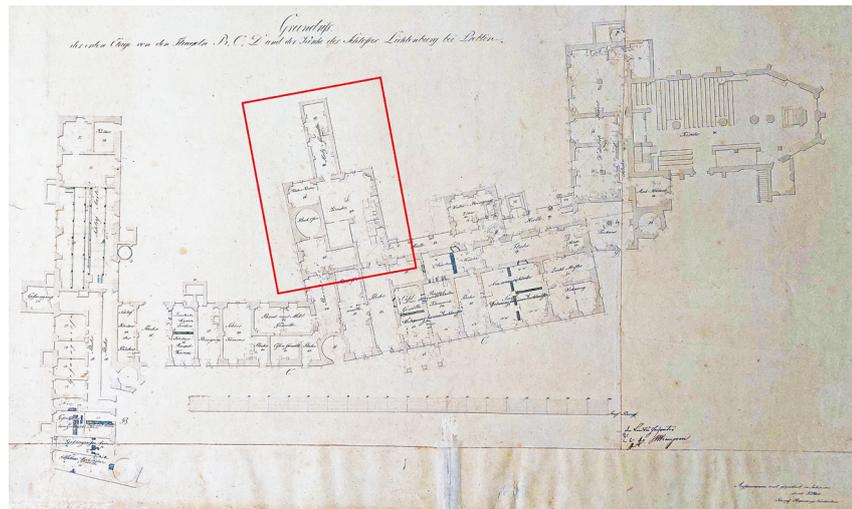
Grundriss des 1. Obergeschosses Schloss Lichtenburg, 1822, in Rot markiert der Raum der ehemaligen Drechselstube von Kurfürst August, der im 17. Jahrhundert unterteilt wurde. Landesarchiv Sachsen-Anhalt, C 48 IX Regierung Merseburg. Plankammer, Lit. K Nr. 115c.
